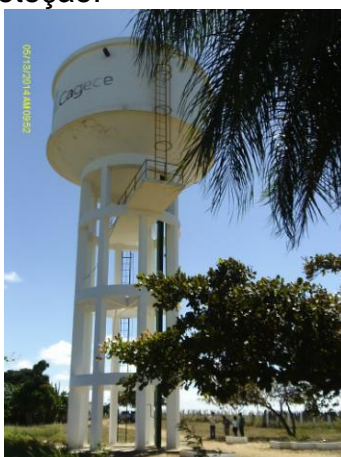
RAP-01: tanque para aplicação de cloro.
